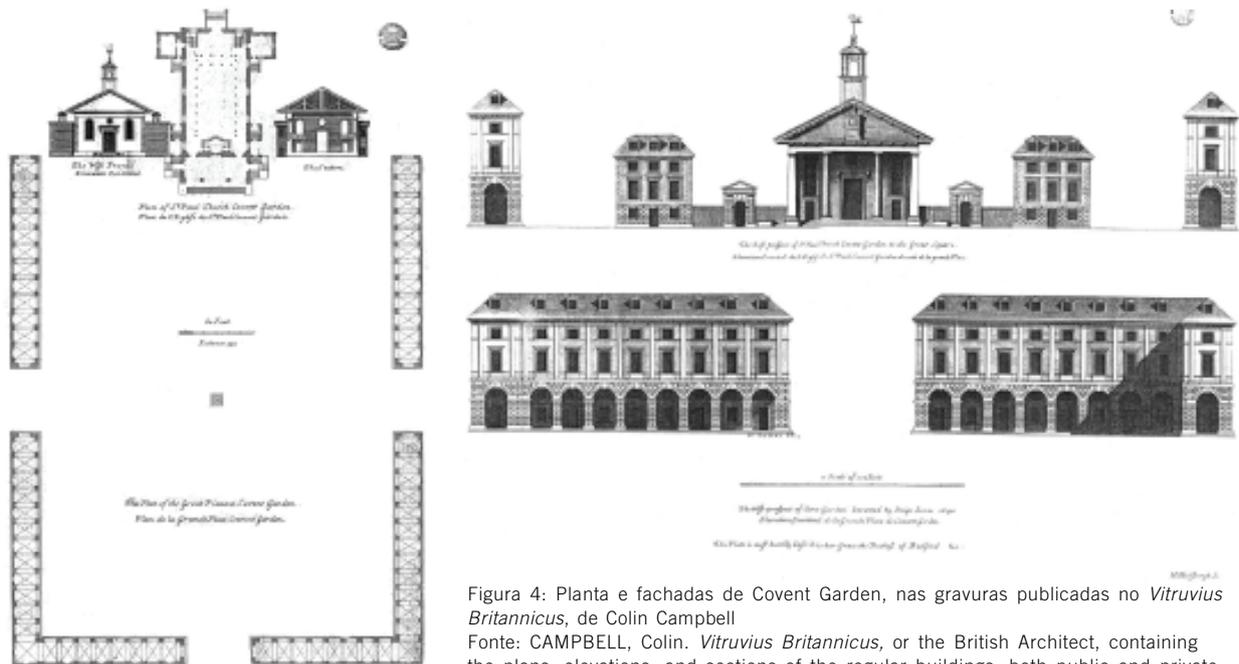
Planta e fachadas de Covent Garden, nas gravuras publicadas no *Vitruvius Britannicus*, de Colin Campbell
